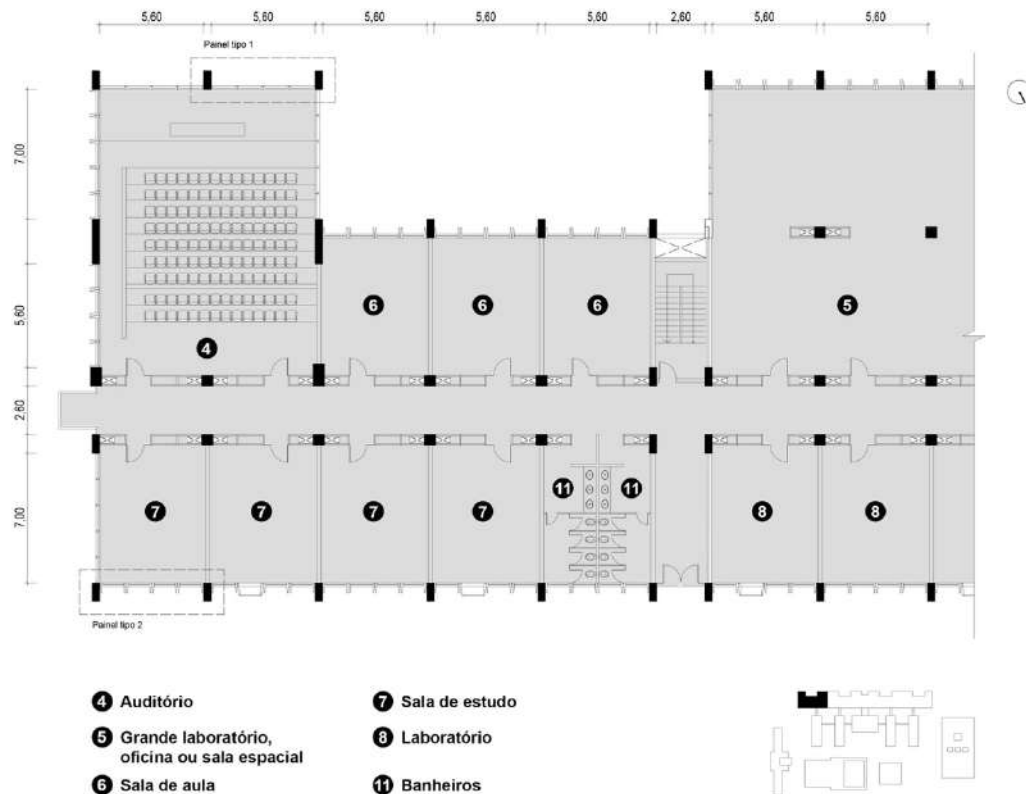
Trecho da Planta Baixa do Pavimento Tipo do bloco F do Pavilhão João Lyra Filho.
